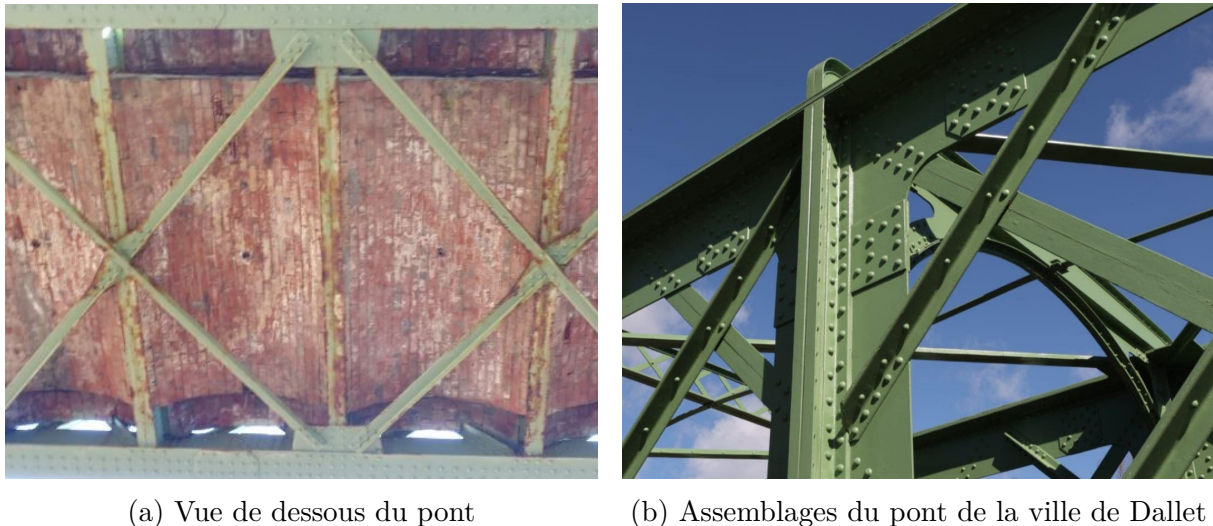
Pont de la ville de Dallet avant rénovation
